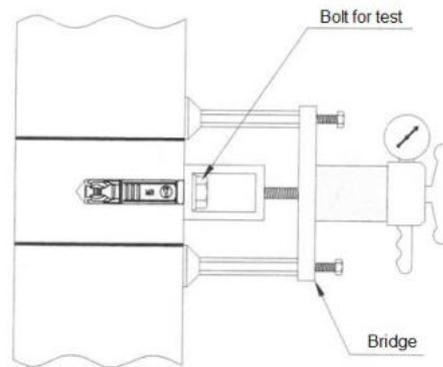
Exemple de banc d'essai pour vérifier une ancre dans un mur
